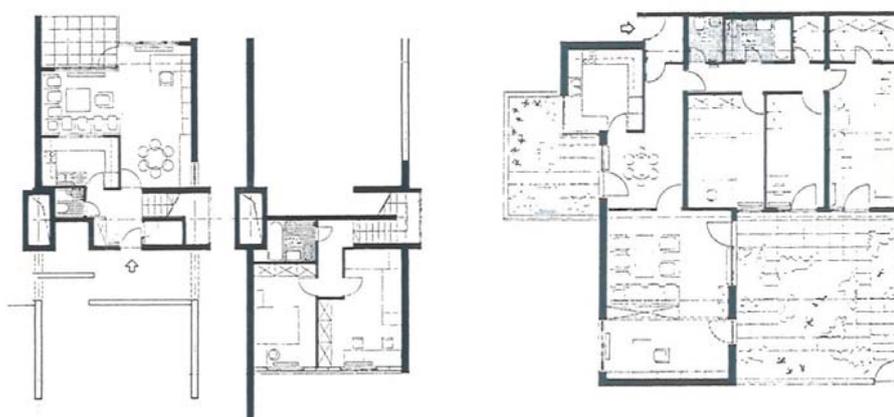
Grundrissvariante 3-Zimmer Maisonettewohnung im Turm (l)
